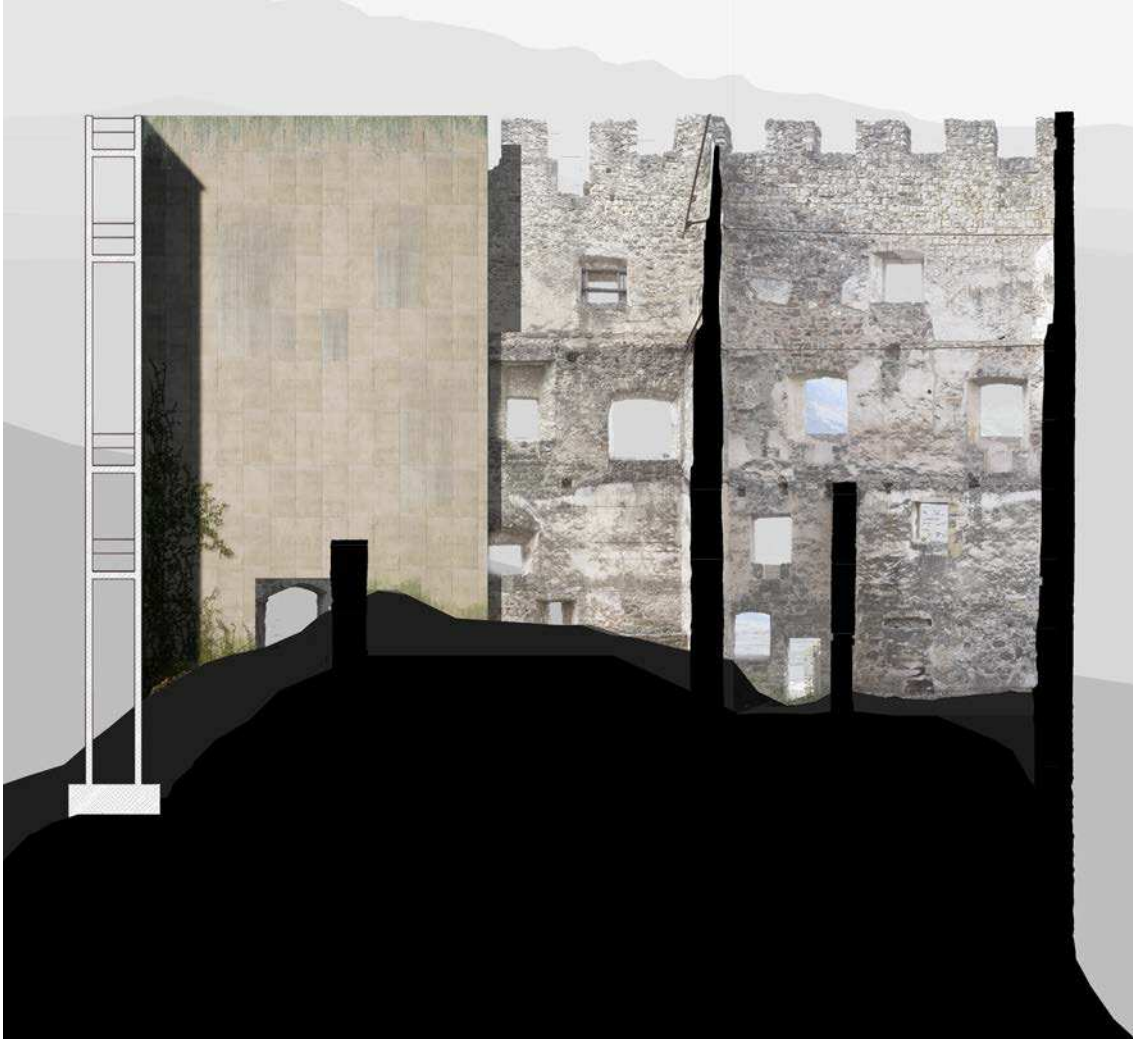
Fassadenschnitt, Vervollständigung der Silhouette
